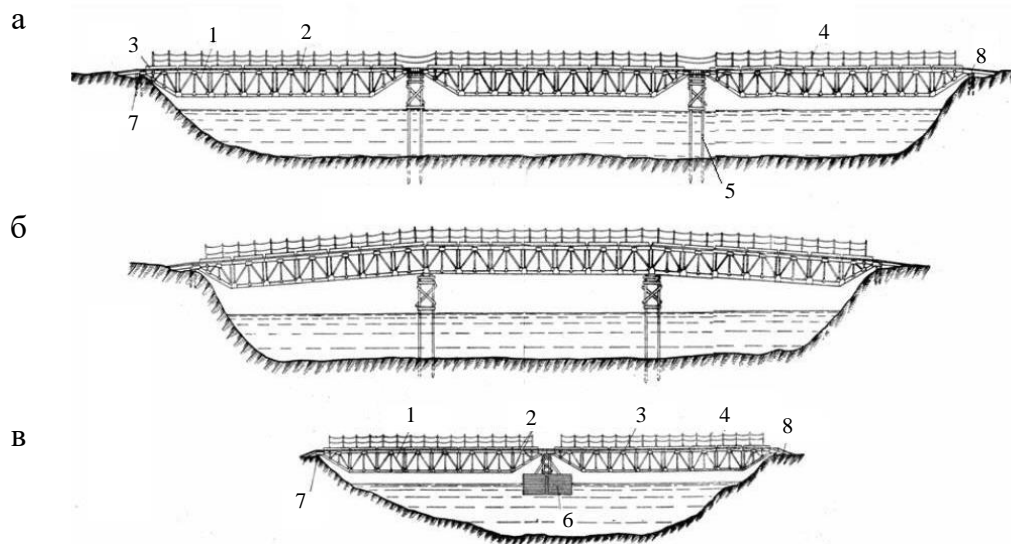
Схеми мосту із комплексу РММ-4: а, б – на жорстких опорах; в – на плавних опорах: 1 – головні ферми; 2 – щити для настилу; 3 – колесовідбійник; 4 – перильні стійки; 5 – проміжна опора; 6 – проміжна плавна опора; 7 – береговий лежень; 8 – сходи
